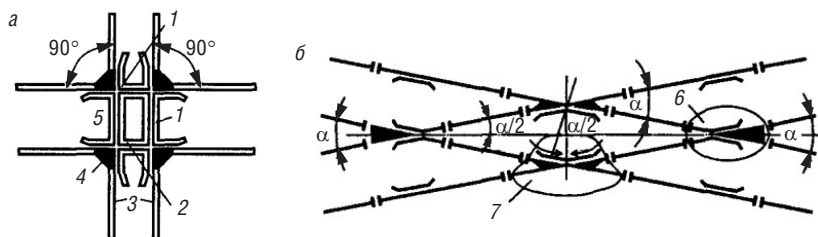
Глухое (а) и косоугольное (б) пересечения:
